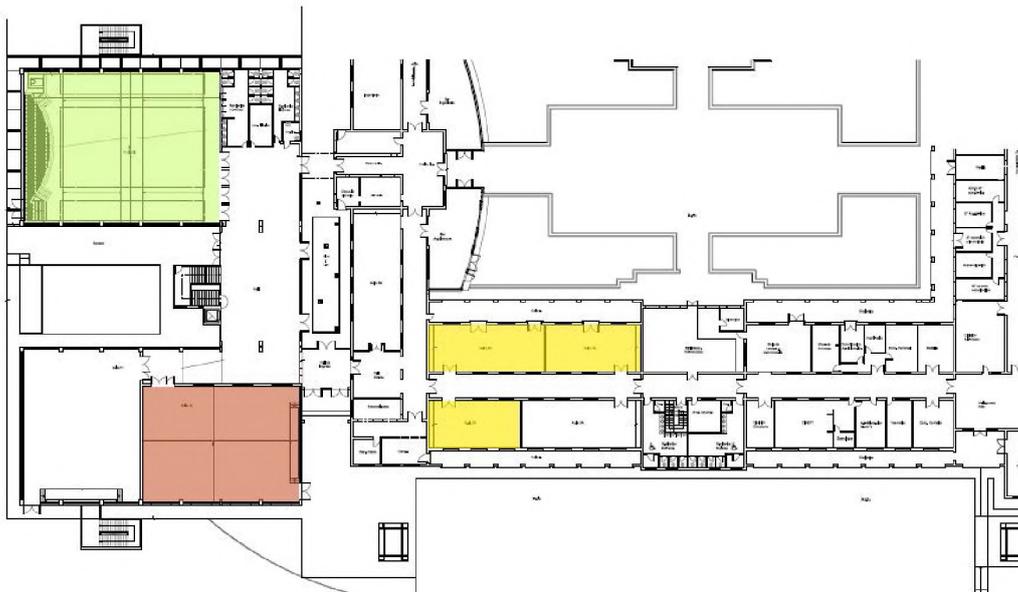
Ubicación de los locales que monitorear: planta baja – FAU-UNNE. Fuente: elaboración propia
